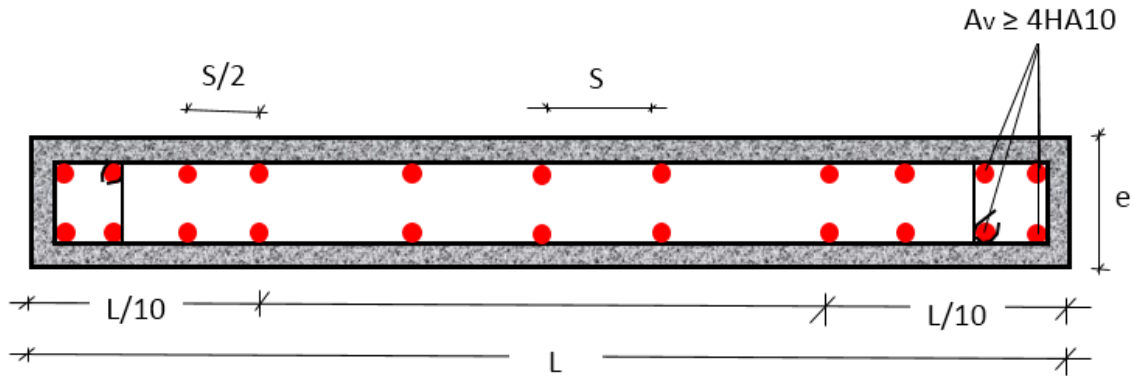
Disposition des armatures verticales dans les voiles.
